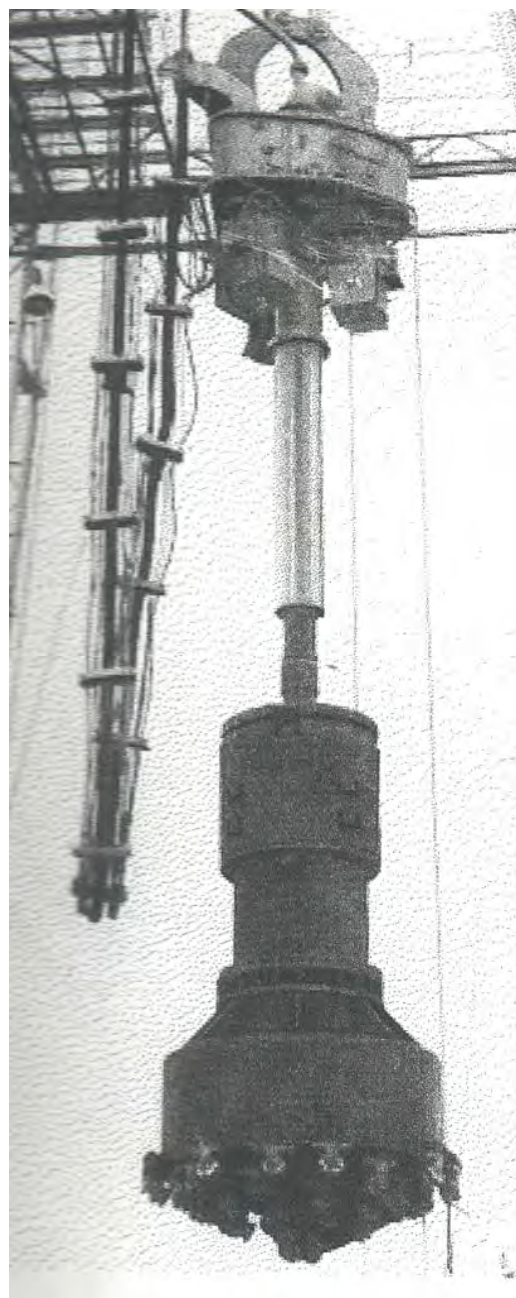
Kraftspülkopf, Schwerstange und Bohrwerkzeug in Brücken
